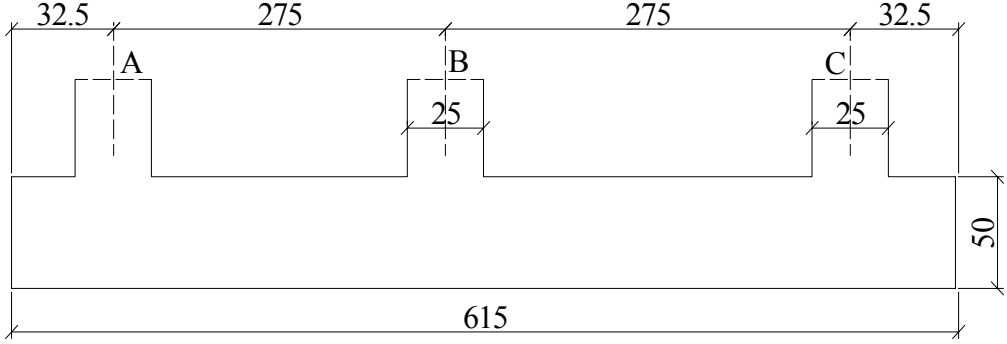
Kazık betonarme temel kesiti Ölçek :1/20
